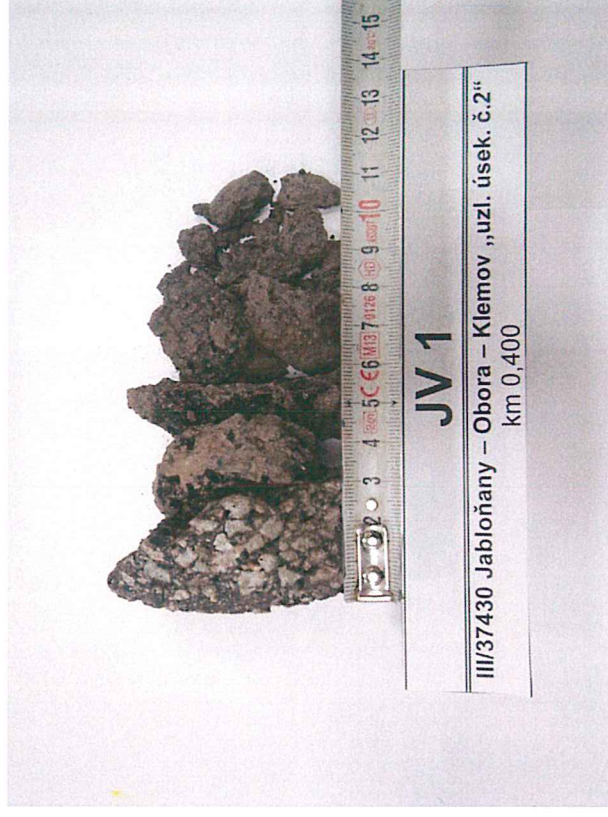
Detail vývrtnu JV 1 (úsek č.2)
